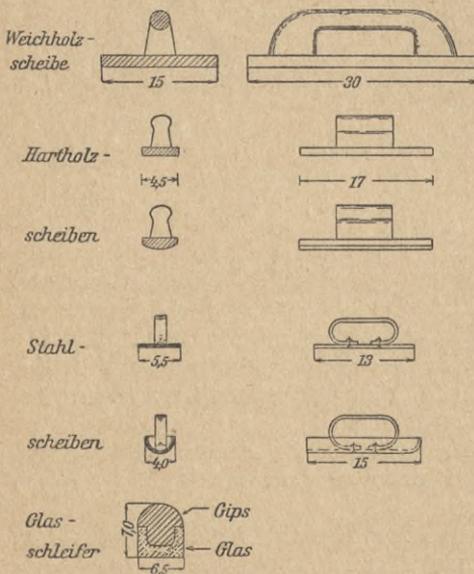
d. Schleifgeräte zur Herstellung wasserdichten Zementputzes. [Handbuch für Eisenbetonbau.]
